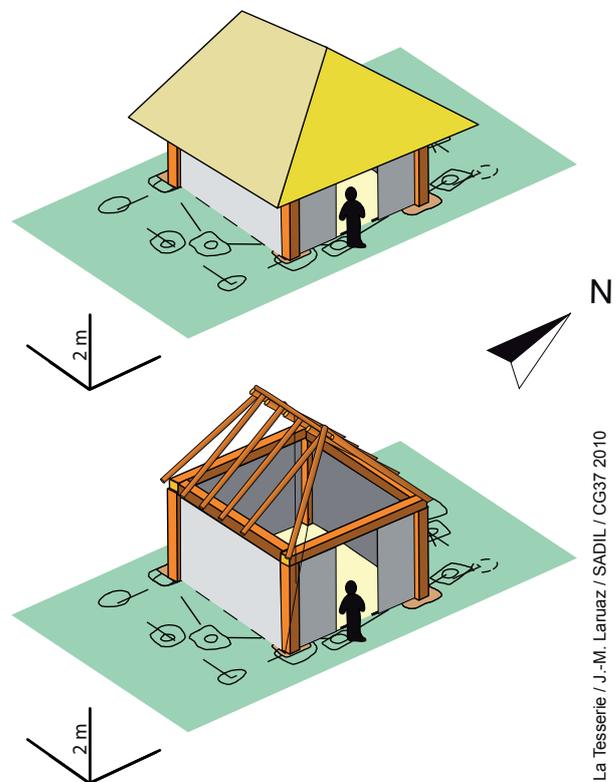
Proposition de restitution des constructions des groupes 3.a et 3.b (d'après le bâtiment A1).
